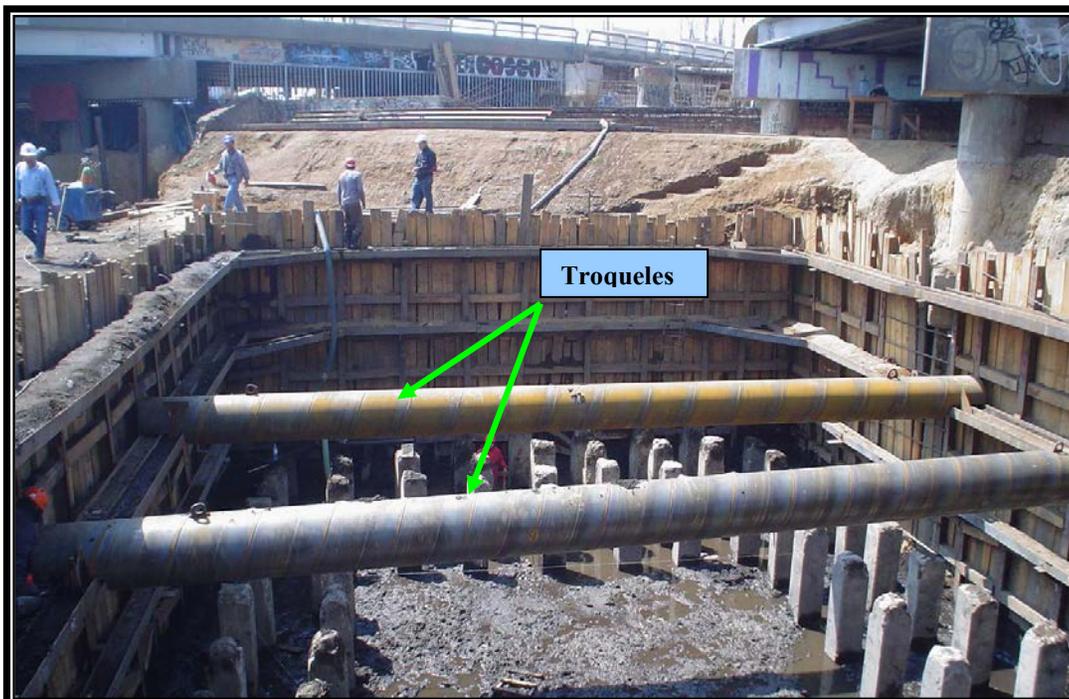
Posición de Troqueles dentro de la excavación para soportar los empujes de suelo.
